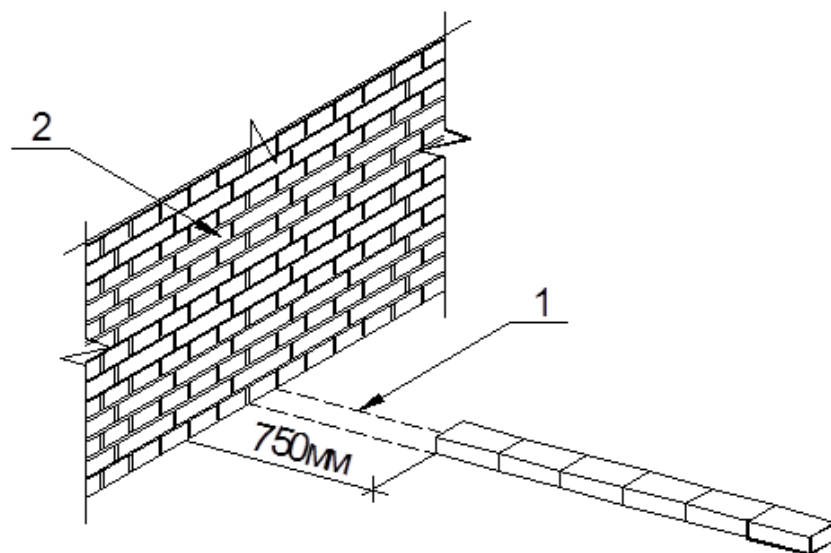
Раскладка кирпича перегородок. 1 – расстояние от стены до кирпича при раскладке, 2 – стена.
